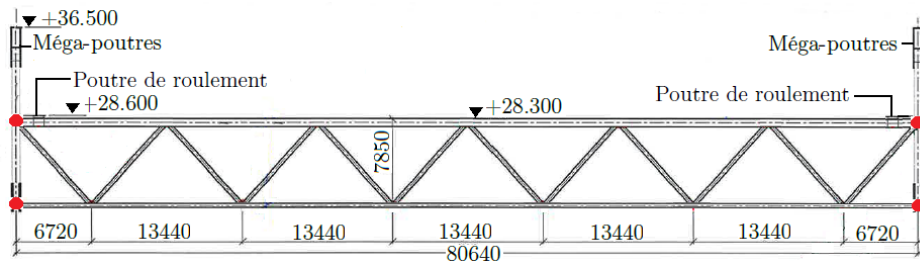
Vue en élévation de la poutre transversale, unité : mm. Source [9], modifiée.
